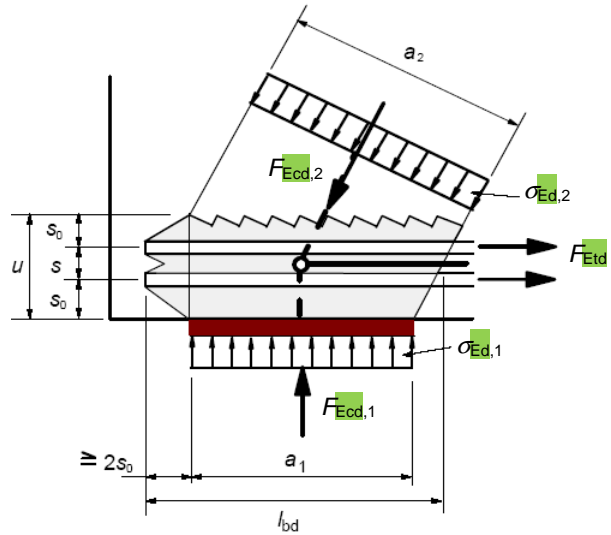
Druck-Zug-Knoten mit Bewehrung in einer Richtung
